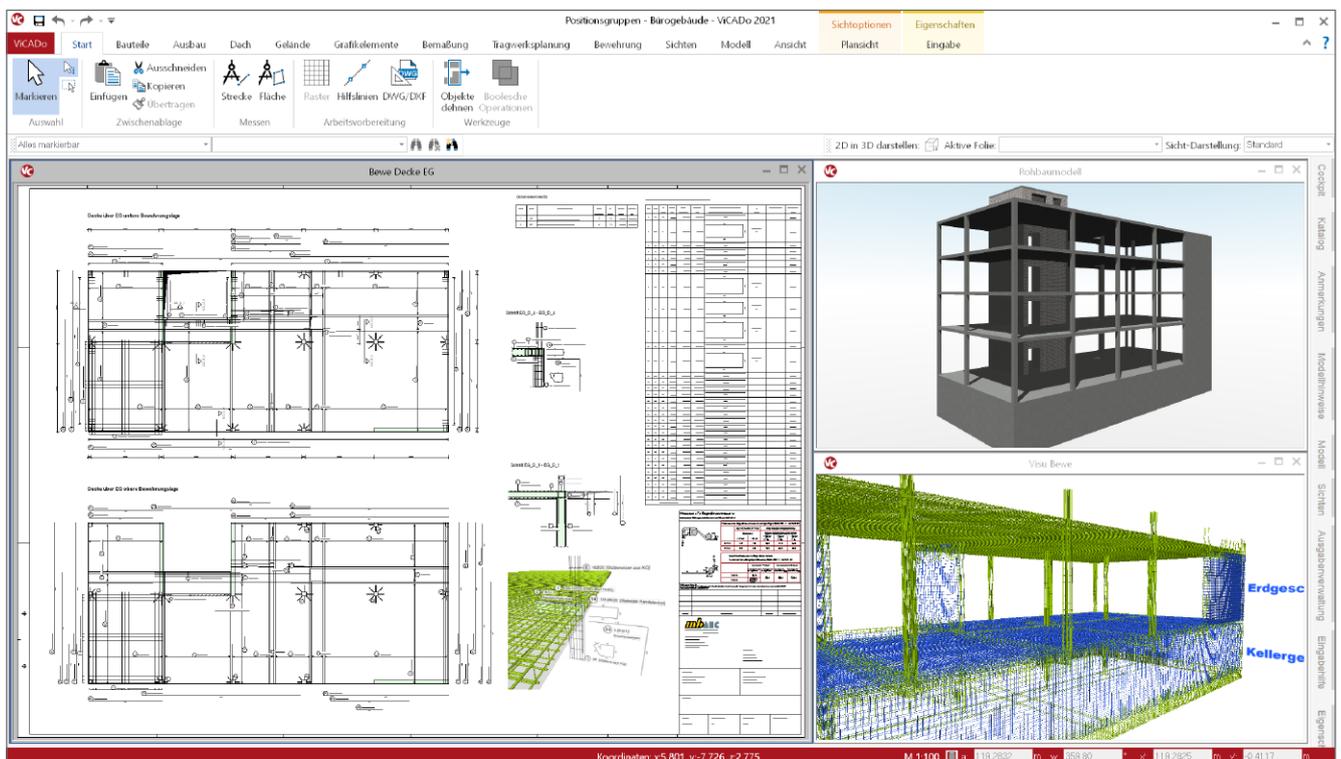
Bewehrungsmodell Bürogebäude ViCADO.ing
